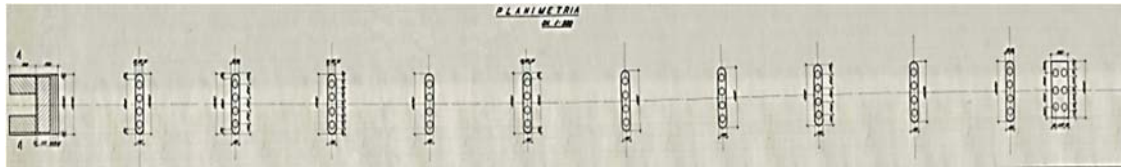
Planimetria. Prerje horizontale në risegën e plintave* ([6])
